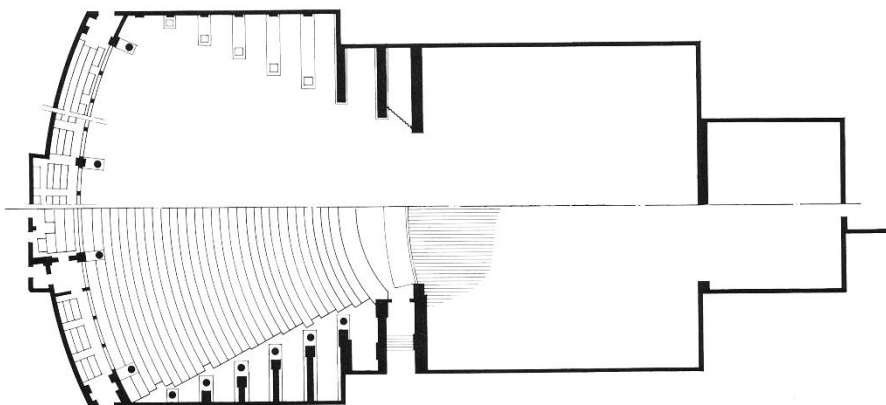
Grundriss Festspielhaus Bayreuth (Beranek 2004, S. 284)
